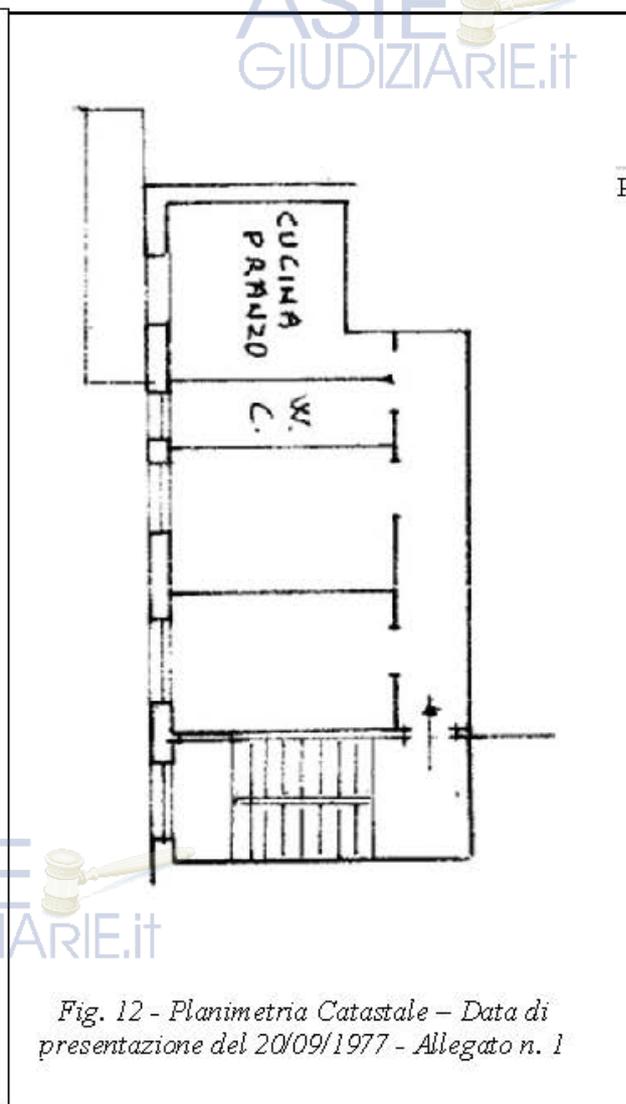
Planimetria Catastale - Data di presentazione del 20/09/1977 - Allegato n. 1
